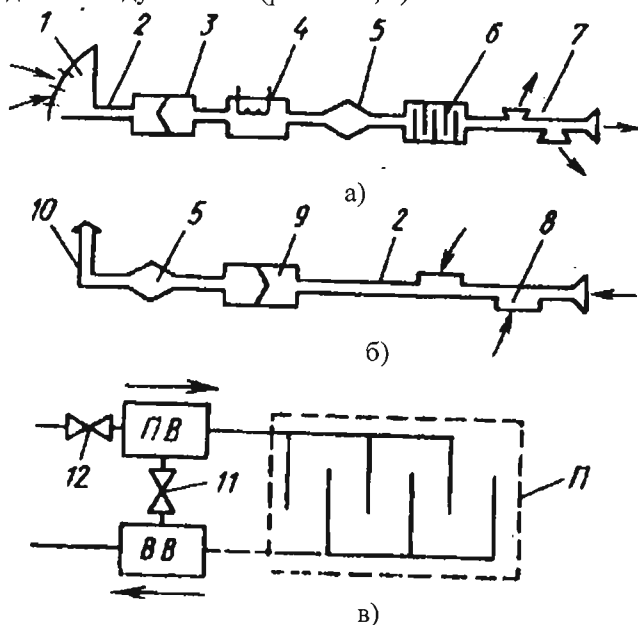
Схемы общеобменной вентиляции: а) приточная вентиляция (1 – воздухозаборное устройство; 2 – воздуховод; 3 – фильтр; 4 – калорифер; 5 – побудитель движения; 6 – увлажнитель – осушитель; 7 – приточные отверстия или насадки); б) вытяжная вентиляция (8 – вытяжные отверстия или насадки; 5 – побудитель движения; 2 – воздуховод; 9 – фильтр; 10 – устройство для выброса воздуха); в) приточно-вытяжная вентиляция с рециркуляцией (11, 12 – клапаны; П – помещение; ПВ – приточная вентиляция; ВВ – вытяжная вентиляция)
